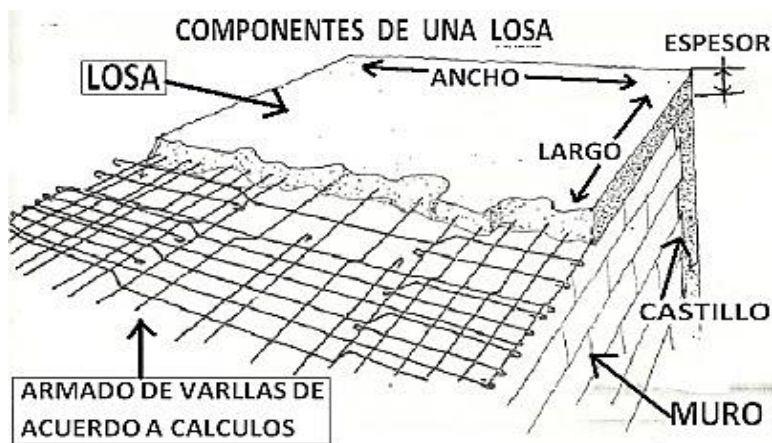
Losas de concreto reforzado. (Blogger, 2010).
